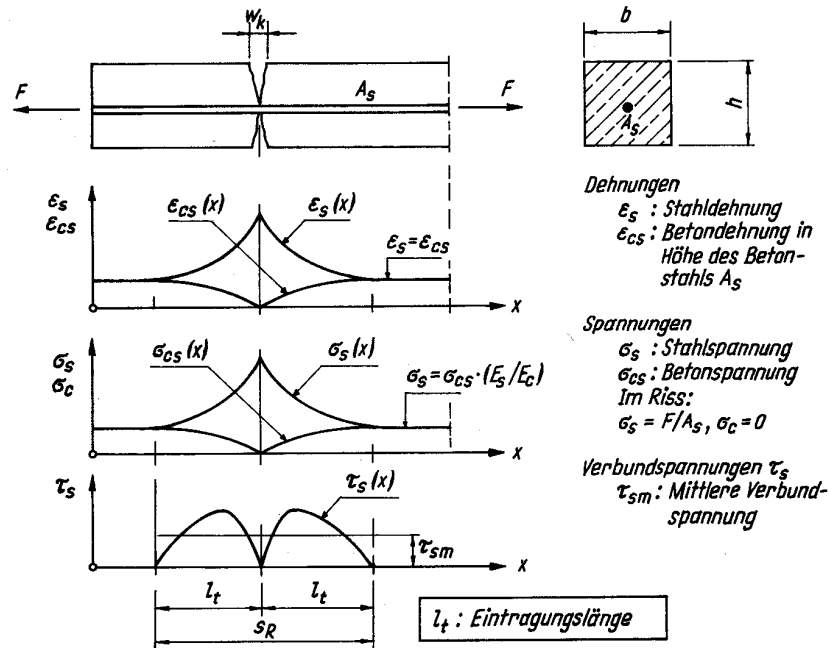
Erstrissbildung bei einem zentrisch gezogenen Stahlbetonstab
